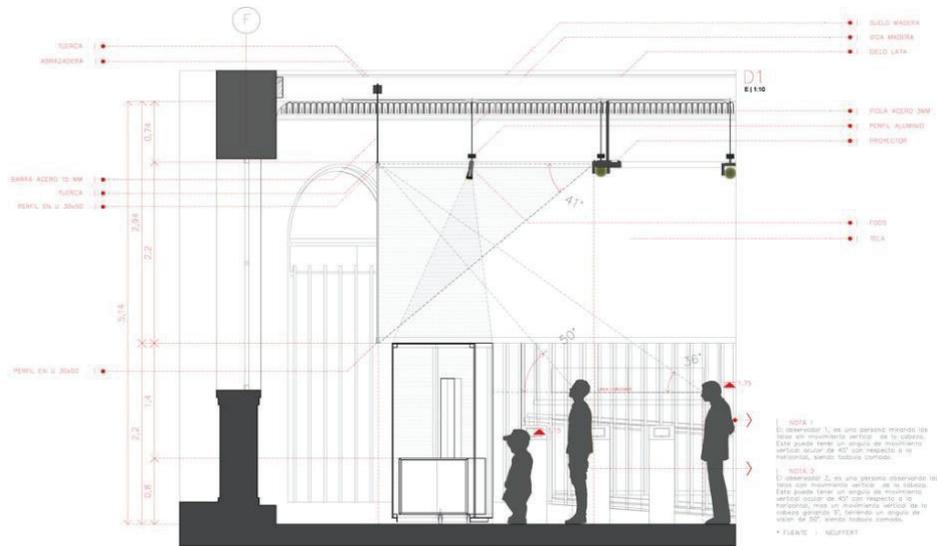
Detalle constructivo y ángulos de visualización. (Neufert, 1995)
